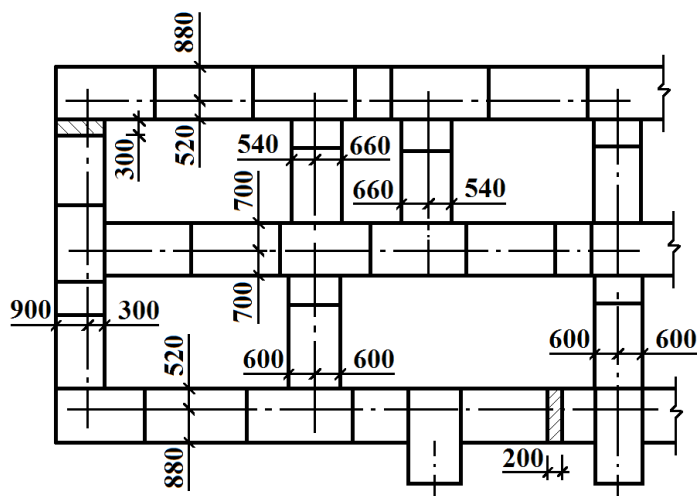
Разбивка ленточного фундамента на отдельные подушки
